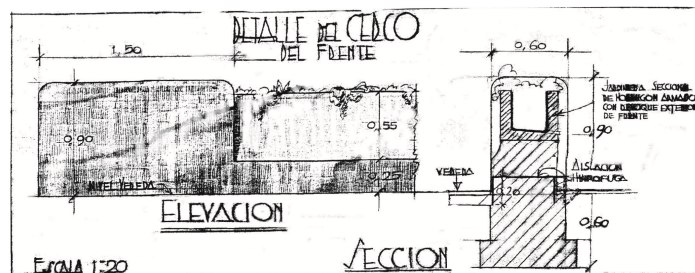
“Detalle del cerco del frente”, 1937. Ministerio de Obras Públicas, en Archivo LEMIT
